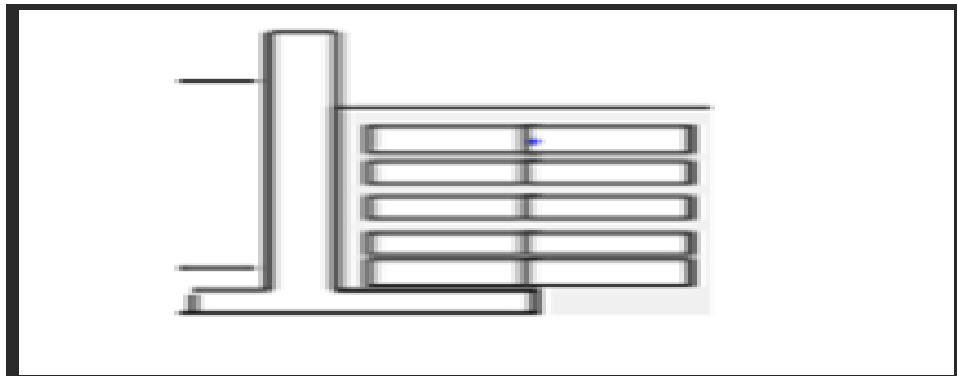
Disposition des Pneu-sol derrière le mur cantilever [3]
